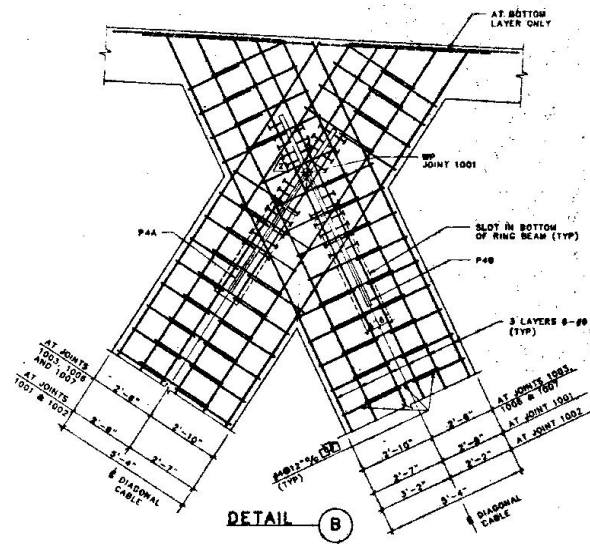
Georgia Kubbesi Çelik Halat Betonarme ankraj bağlantı detay kesiti
